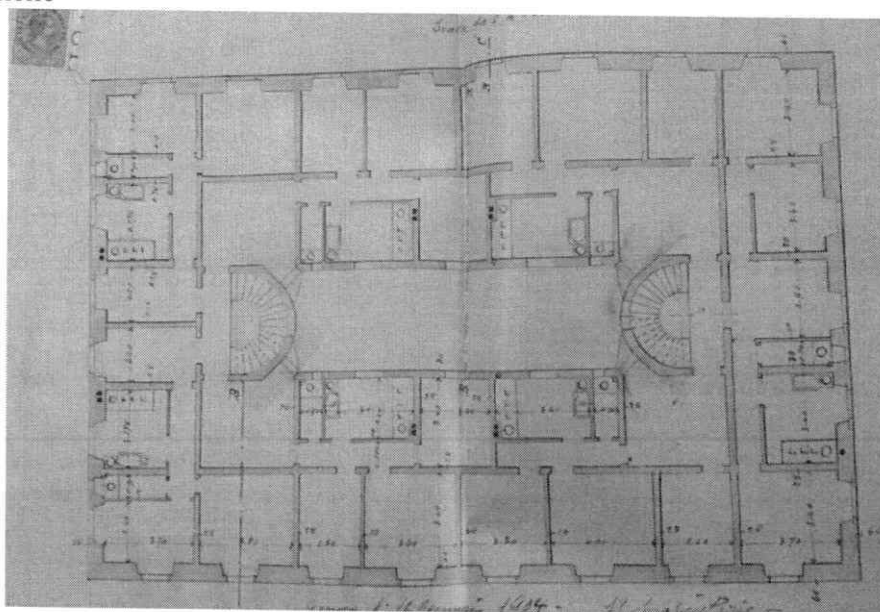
Planimetria piano tipo abitabile nel progetto 1904/1930
